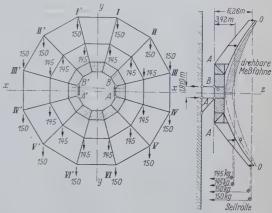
Verformungsmessung, Schema der Lagerung und Lastanordnung (alle Lasten in kg)
